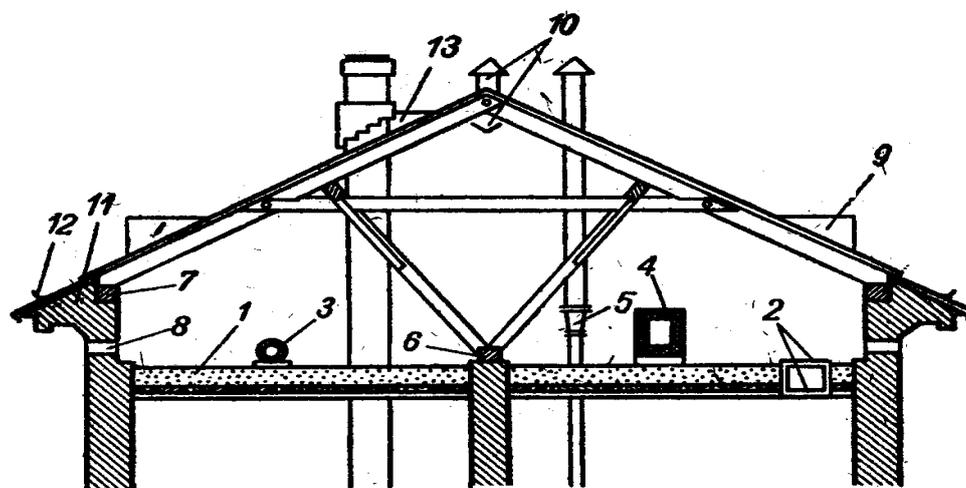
Конструктивное оформление чердачного перекрытия, чердака и крыши: 1 – утепленные перекрытия; 2 – двойные люки; 3 – термоизолированные агрегаты центрального отопления; 4 – термоизолированные вентиляционные каналы; 5 – канализационный стояк, выведенный наружу; 6 – антисептированный и гидроизолированный нижний прогон;
